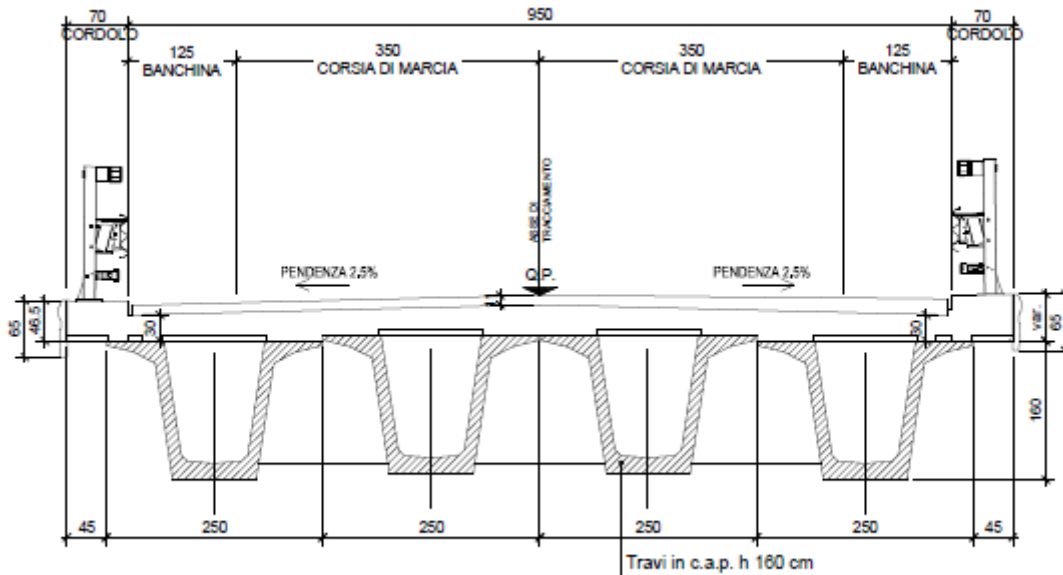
Sezione impalcato Ponte sul Canale di Cento 2
